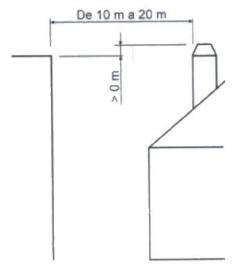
Distanza tra la finitura e oggetti tra 10 e 20 m
